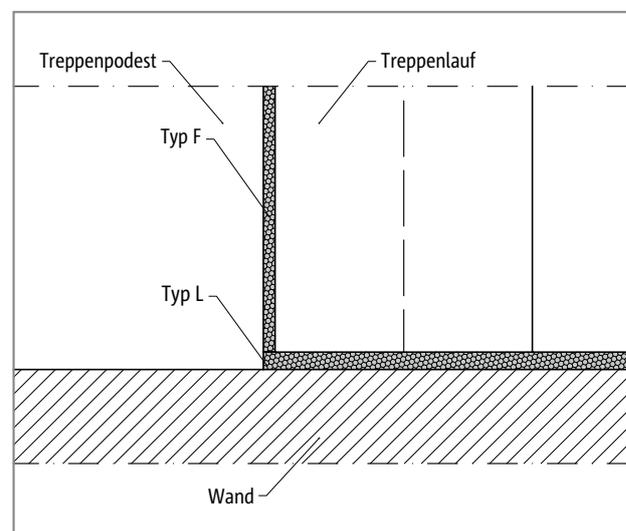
Schöck Tronsole® Typ F: Elementanordnung, Detail B
